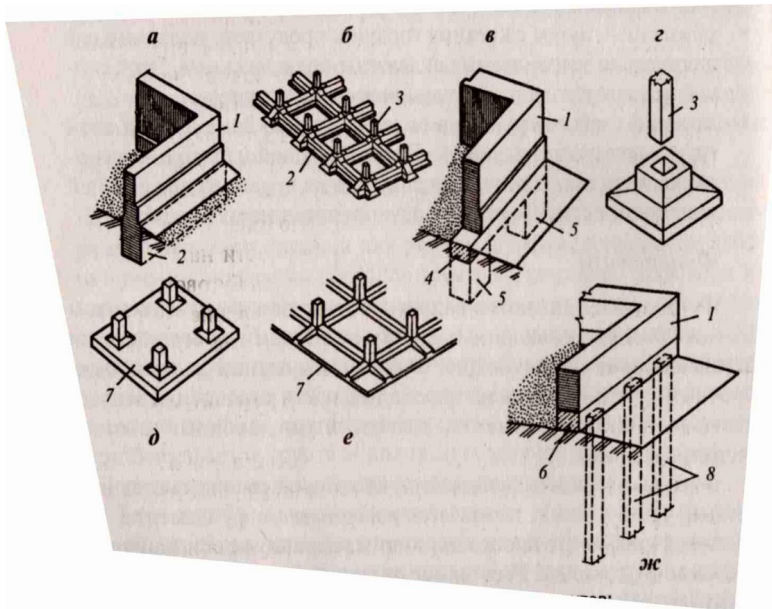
Конструктивные схемы фундаментов: а — ленточный под стены; б — тоже под колонны в столбчатый под стены; в — Отдельный под колонну; д. — сплошной безбалочный; е — сплошной балочный; ж — свайный; 1 — стена; 2 — Ленточный фундамент; 3 — железобетонная колонна; 4 — железобетонная фундаментная балка; 5 — столбчатый фундамент; 6 — ростверк свайного фундамента; 7 —
